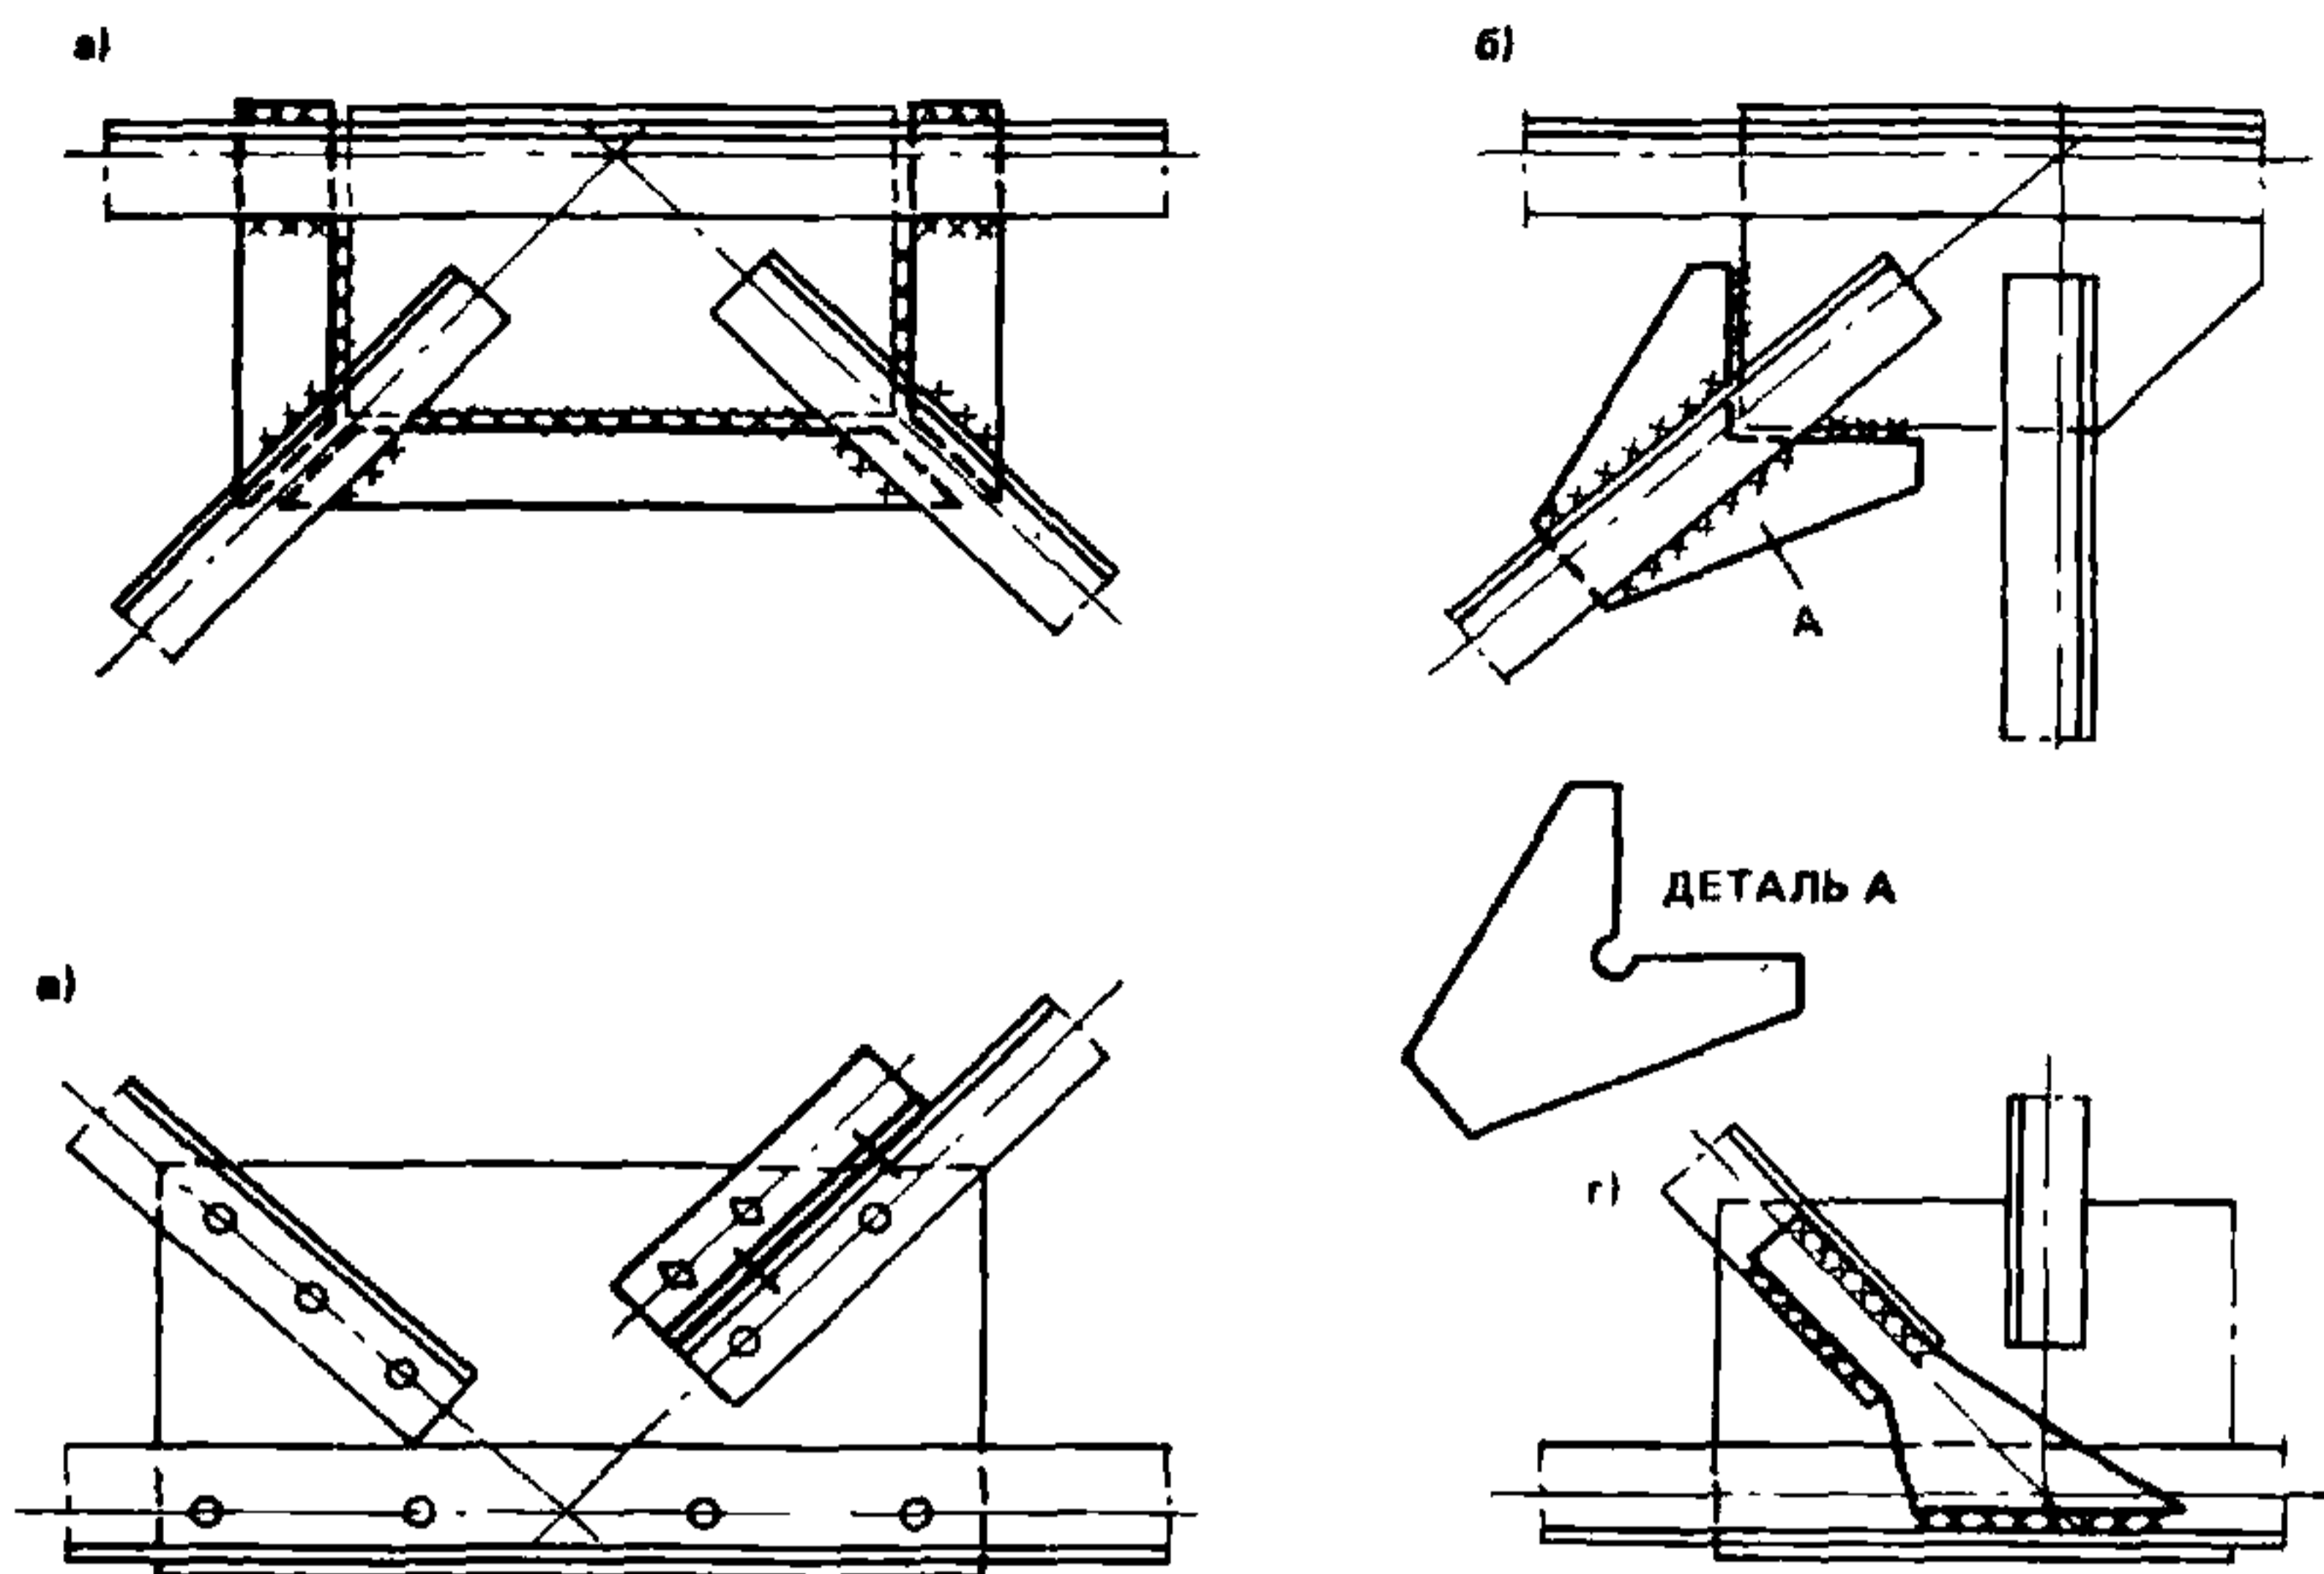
Усиление узлов крепления стержней стропильных ферм
